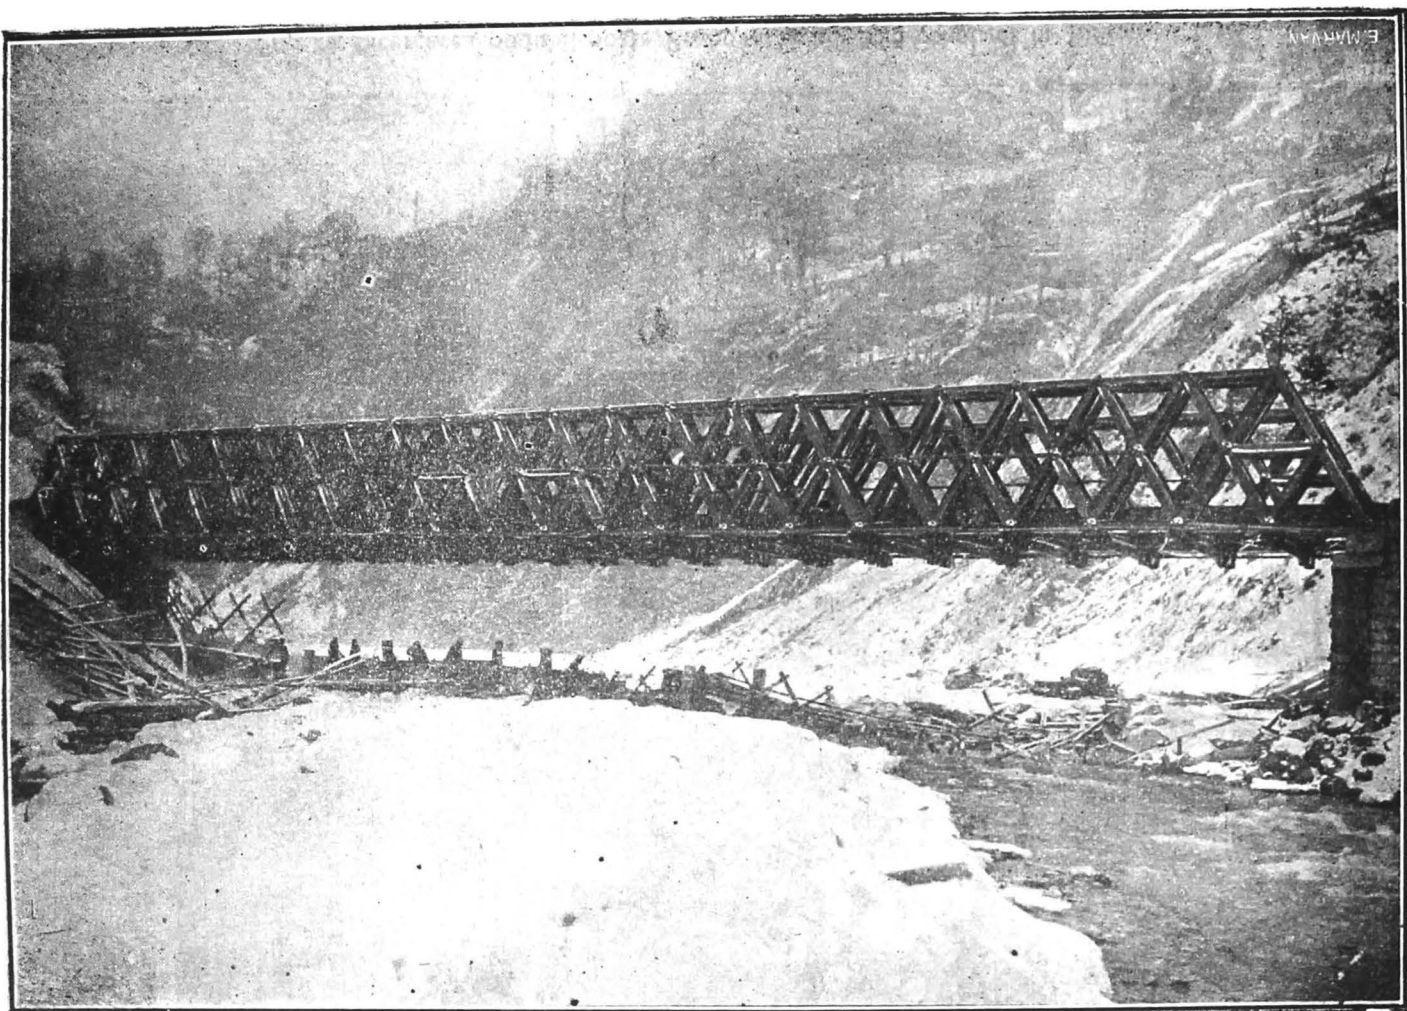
Podul peste Prutova la kil. 56.5 construit in 1917.
